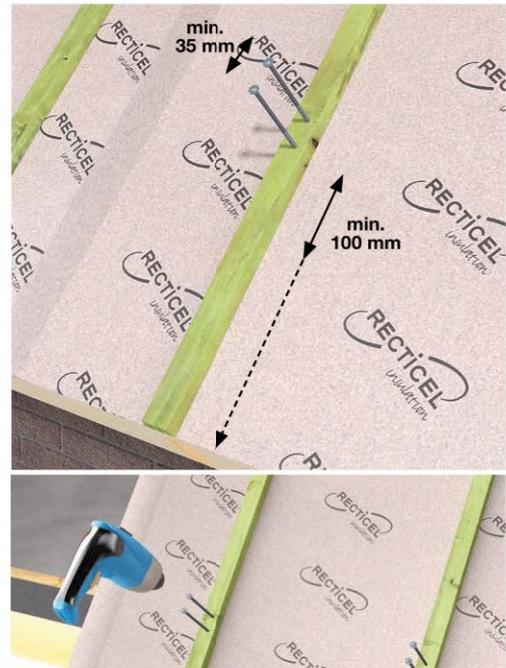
distance minimale entre le bord du panneau et les vis Rectifix®
